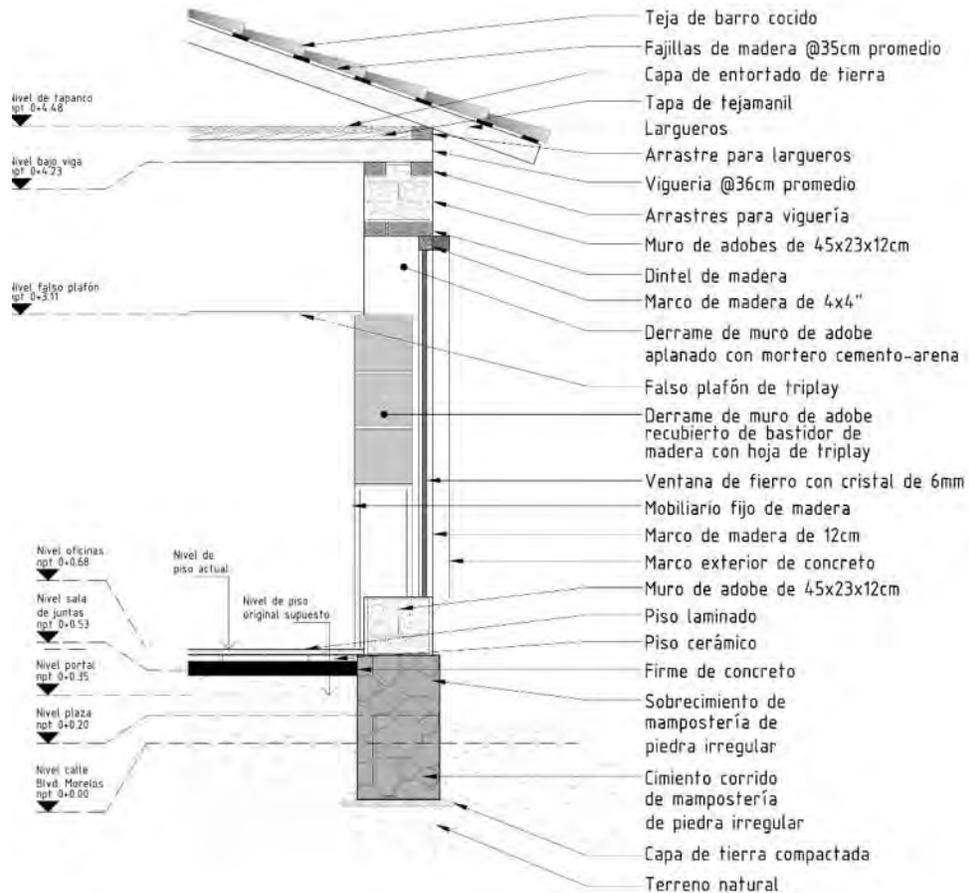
Corte por fachada f1-f1' que corresponde al muro de fachada norte, colindante con calle Blvd. Morelos: en el cual se muestra el esquema general de apoyos mediante sistema de muros. Elaboró: AMT.
